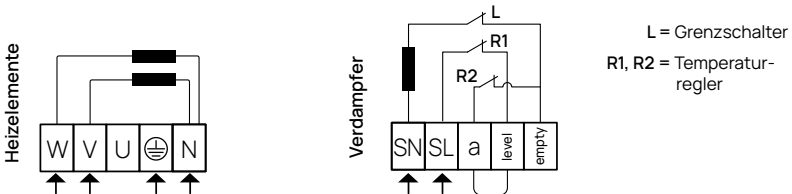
Anschlüsse CORE Wall Mini und CORE Wall Mini Combi.
